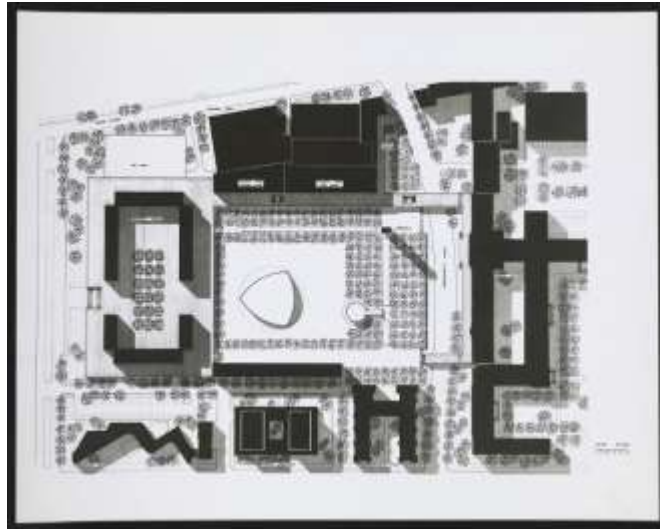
CAMBRIDGE AUDITORIUM KRESGE PLANTA DE CONJUNTO GOOGLE 2022.
